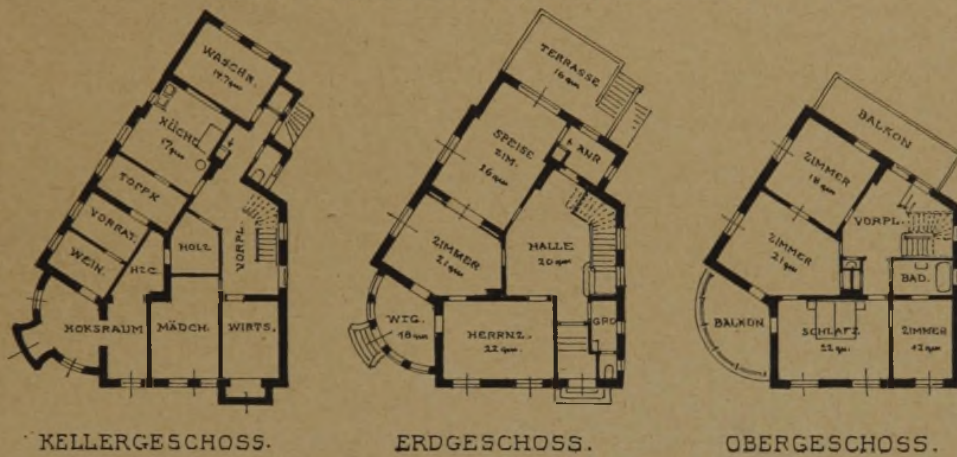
Grundrisse zum Haus Heilwigstraße 148. (1:375)
